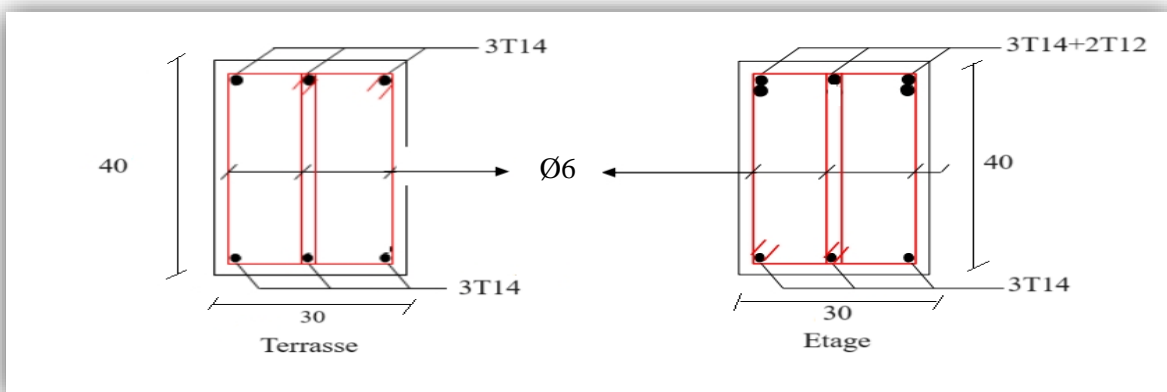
Schéma de ferrailage des poutres principales de rive (Etage et Terrasse).
